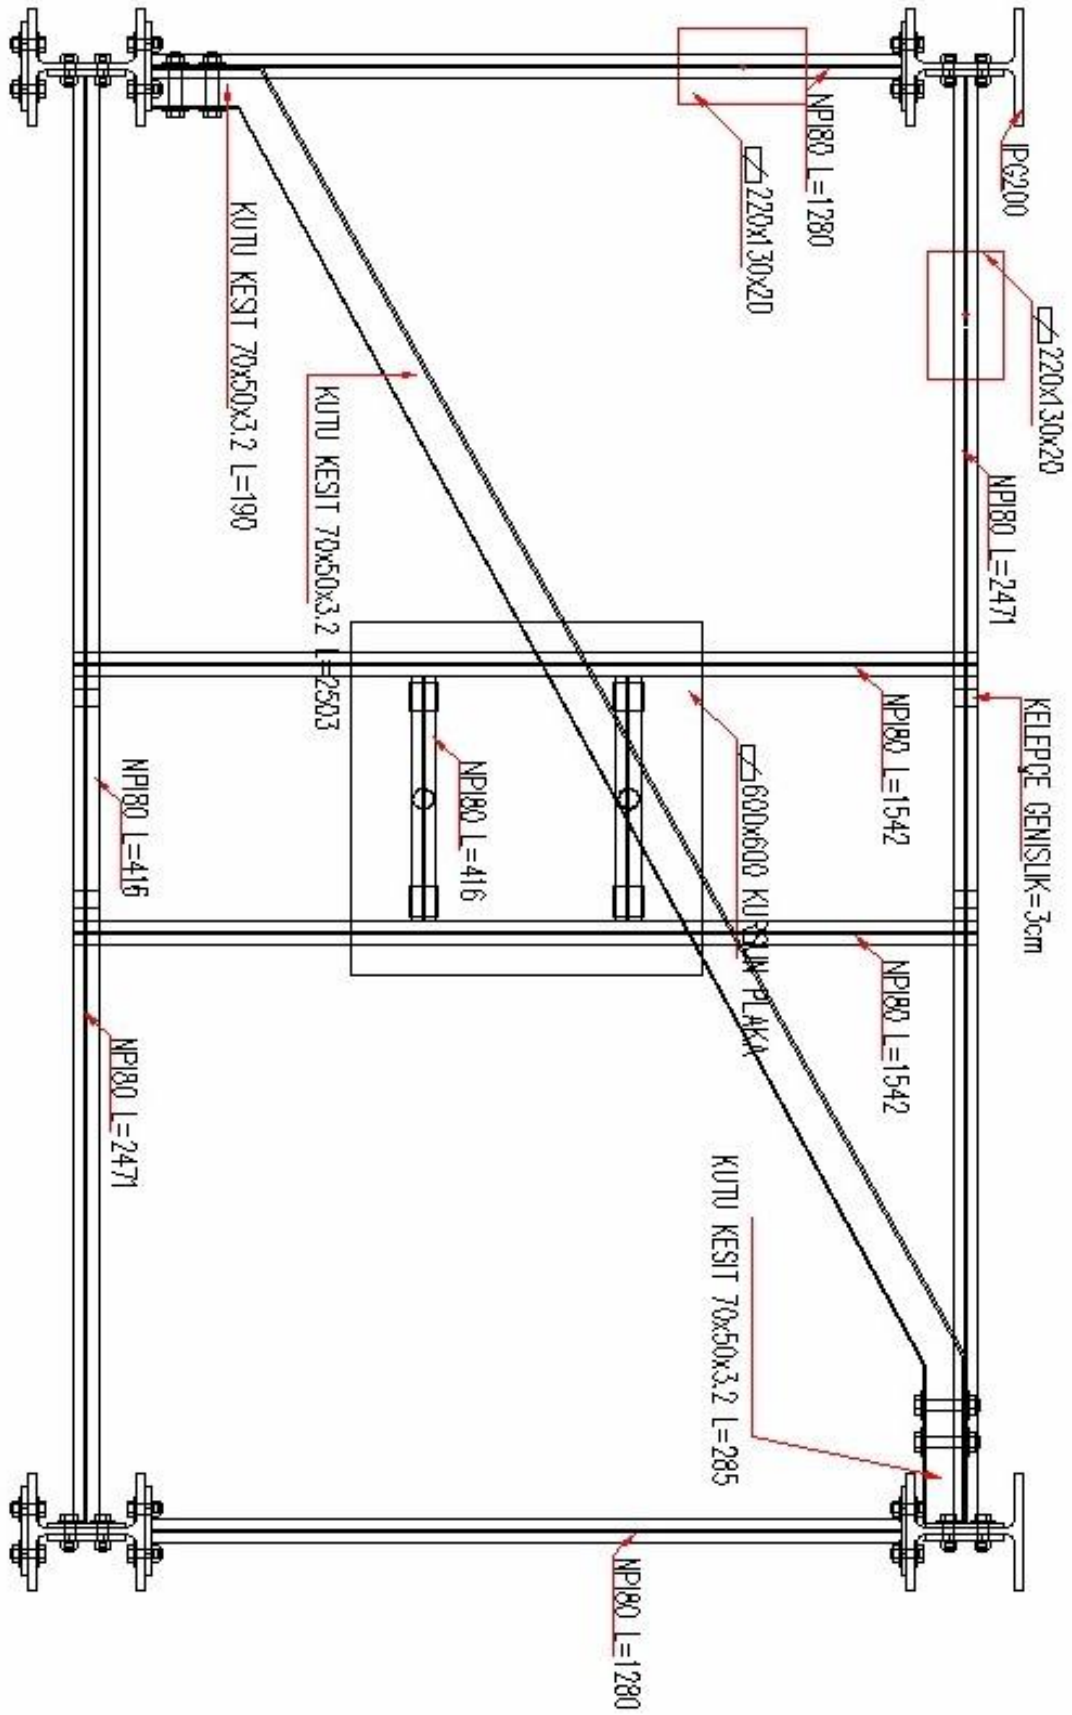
Kolonlar arası bağlantı detayı ve bağlantı levhaları
